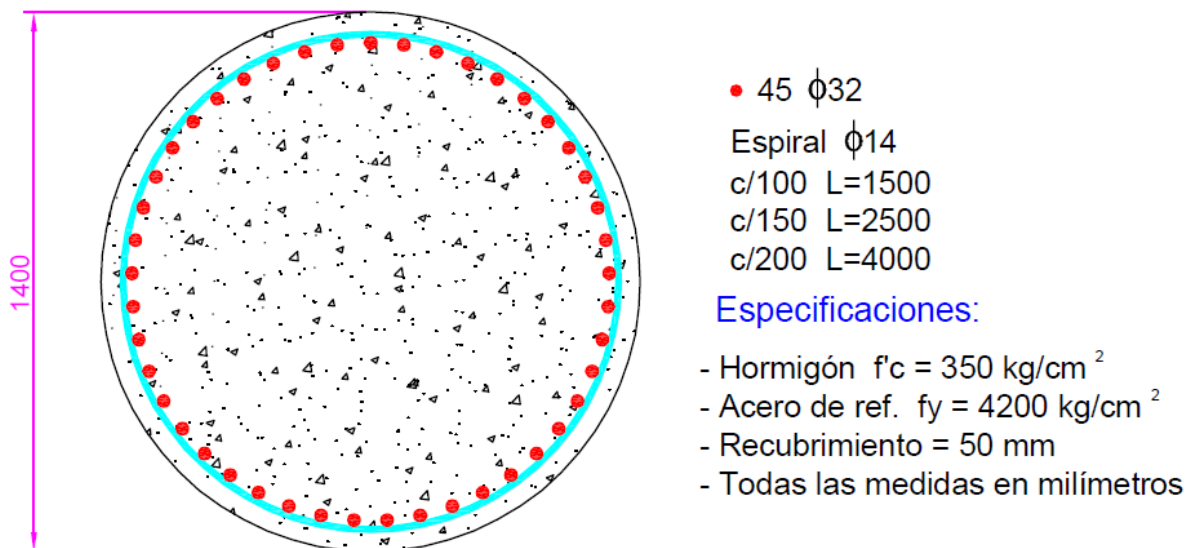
Distribución de acero de refuerzo en columna de la pila – ejemplo 3.3
